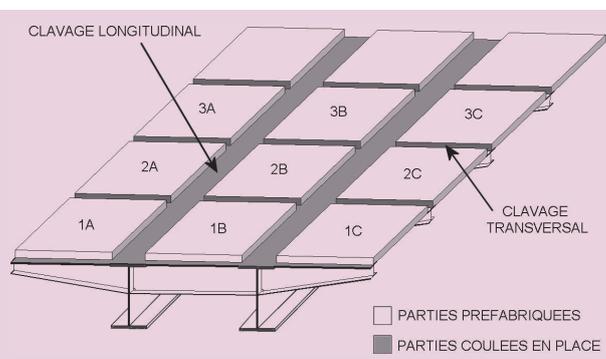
Répartition préfabrication/coulage en place pour un bipoutre à pièces de pont avec consoles
